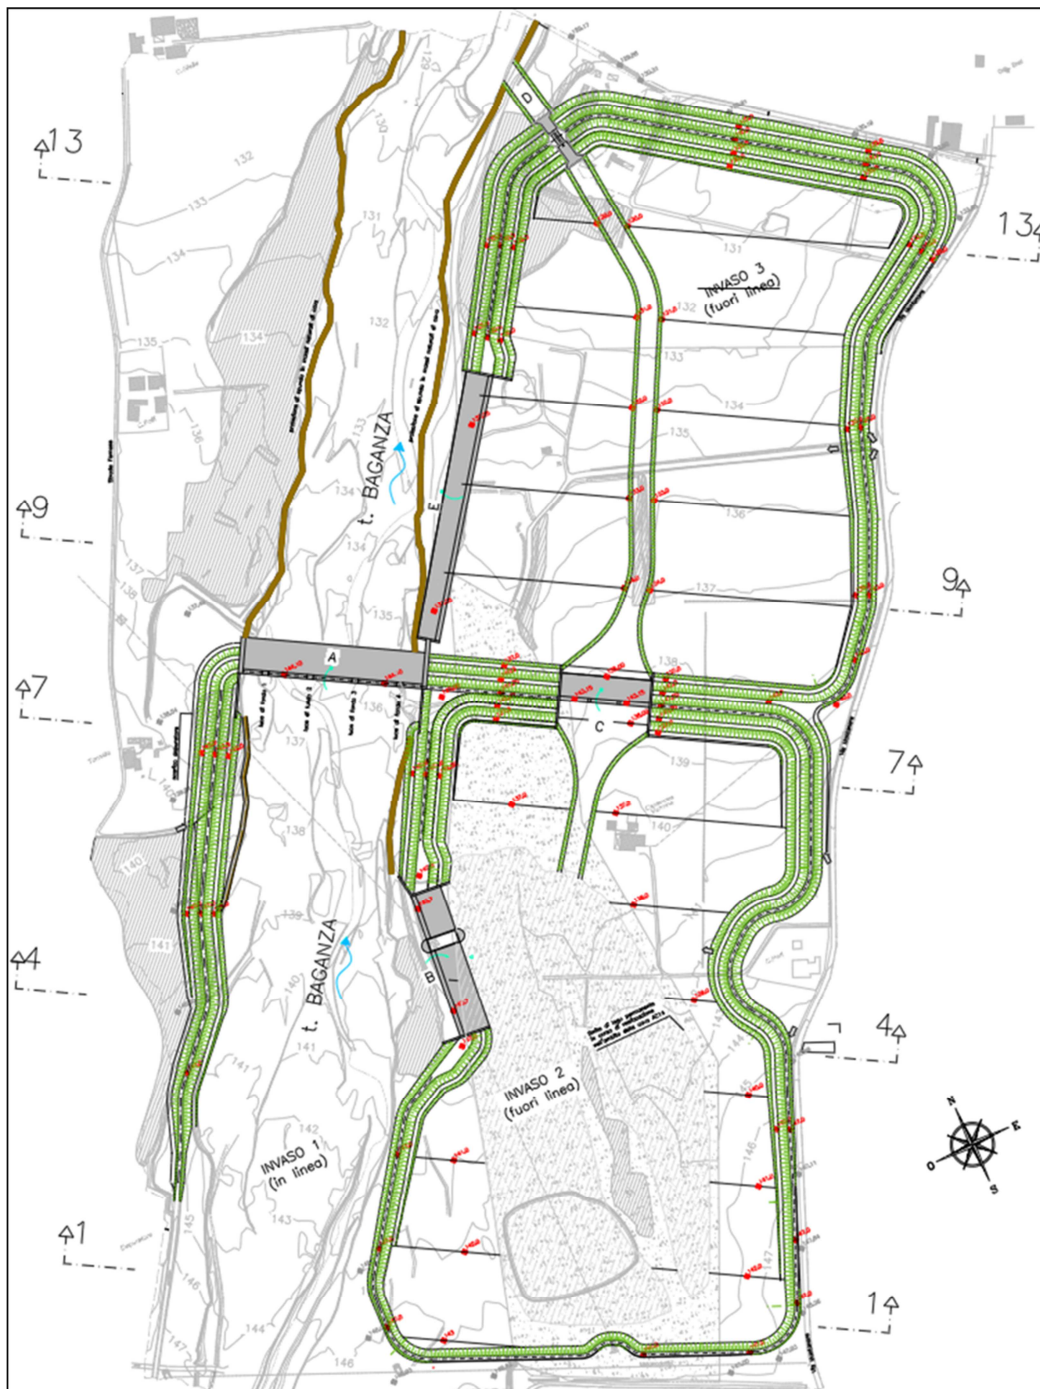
Progetto preliminare (2004) della cassa di espansione sul t. Baganza (da [2]).
